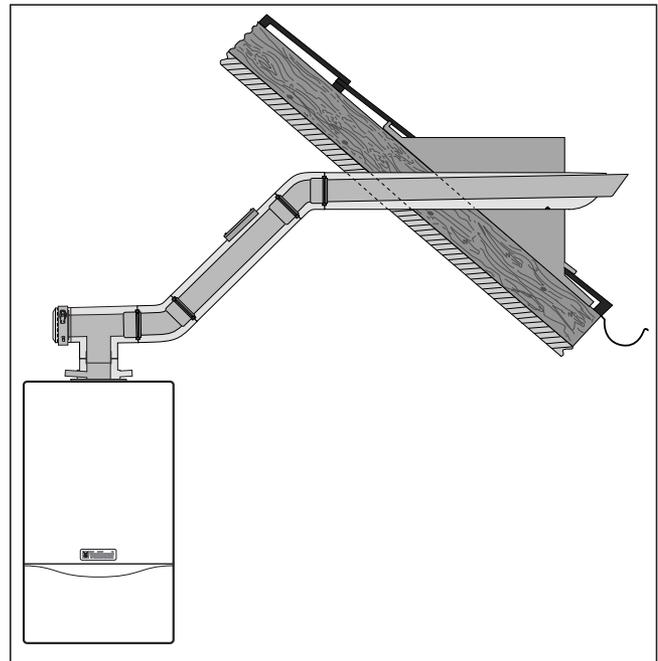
Montagebeispiel: Waagerechte Dachdurchführung
